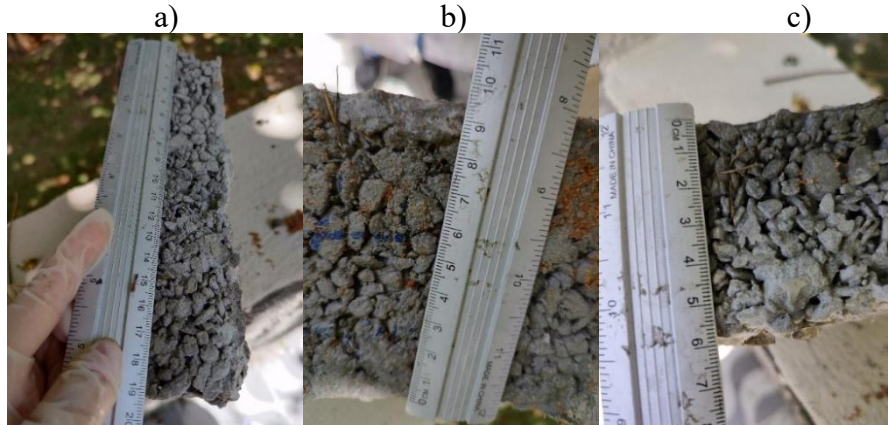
Dimensões *paver* em Concreto Permeável, sem pigmentação.
